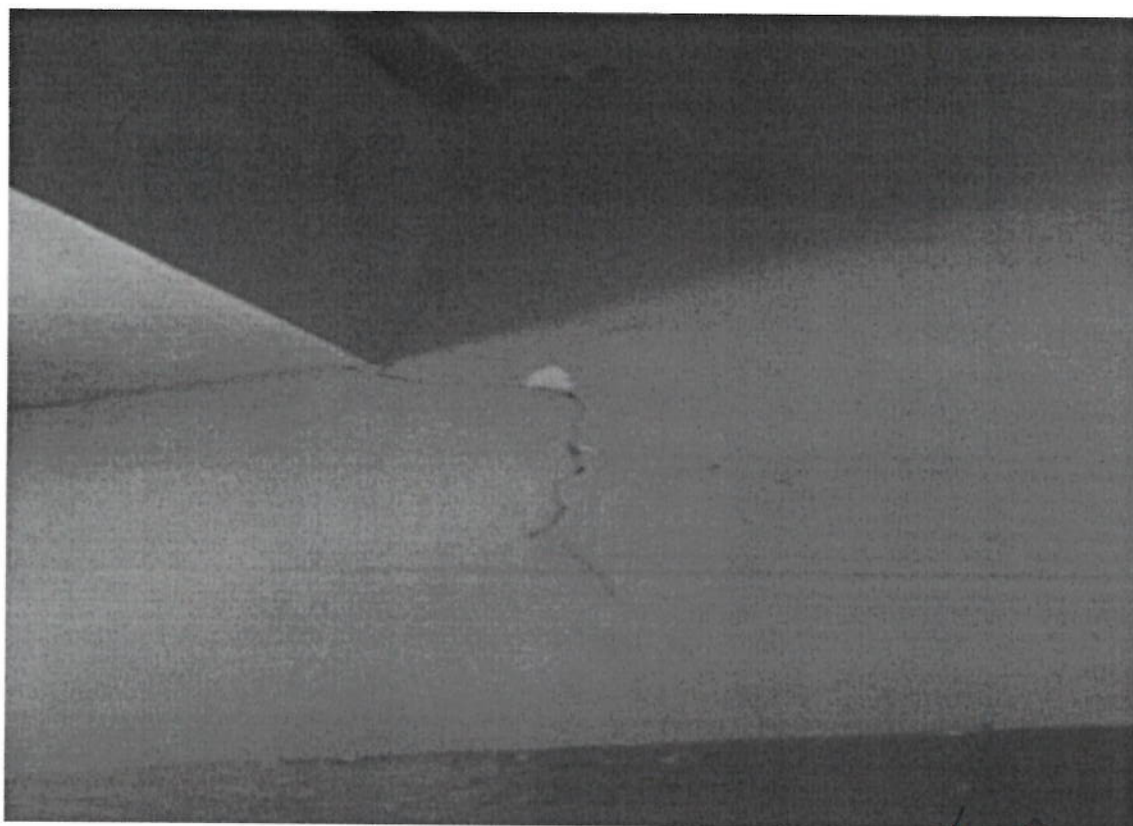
Se observa las paredes, hay grietas considerable, son clara señal de que existe desprendimiento.
